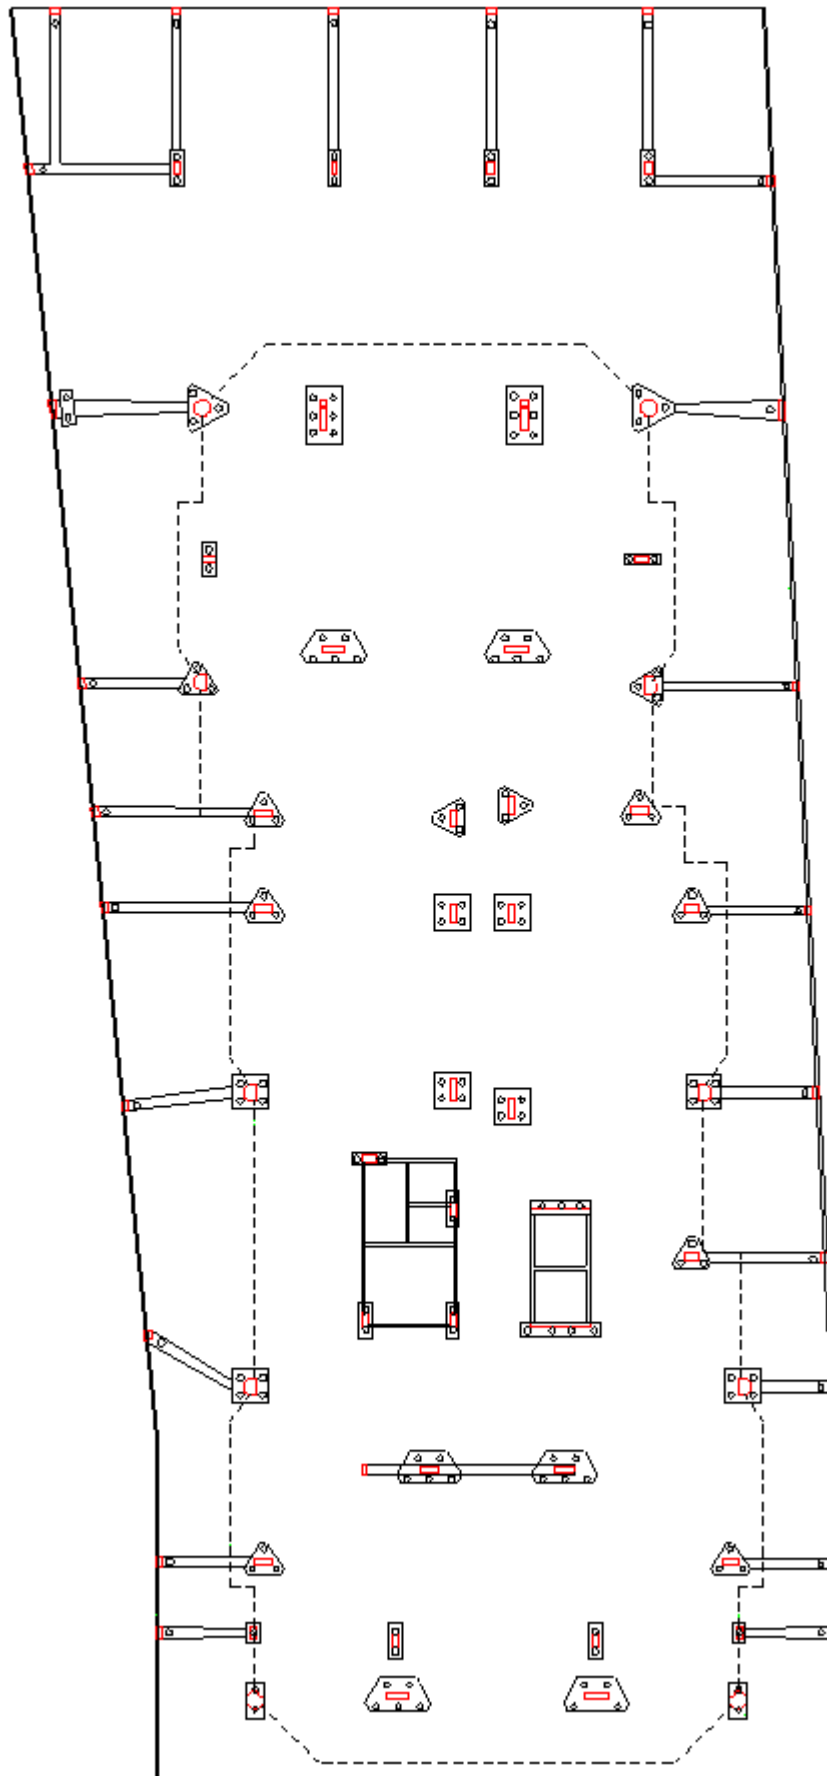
Planta típica de formas dos blocos de fundações e vigas de equilíbrio [1]
